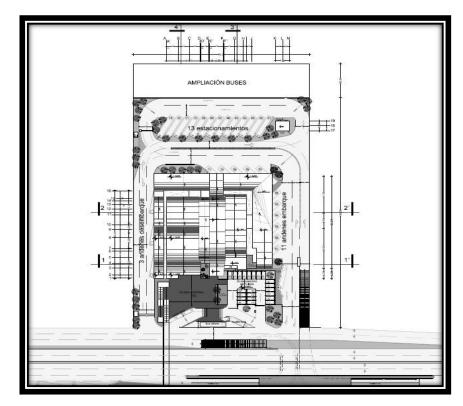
Planos del terminal Tipo 3 para el cantón Archidona (Vista Aérea) Fuente: (Túqueres, 2017).
